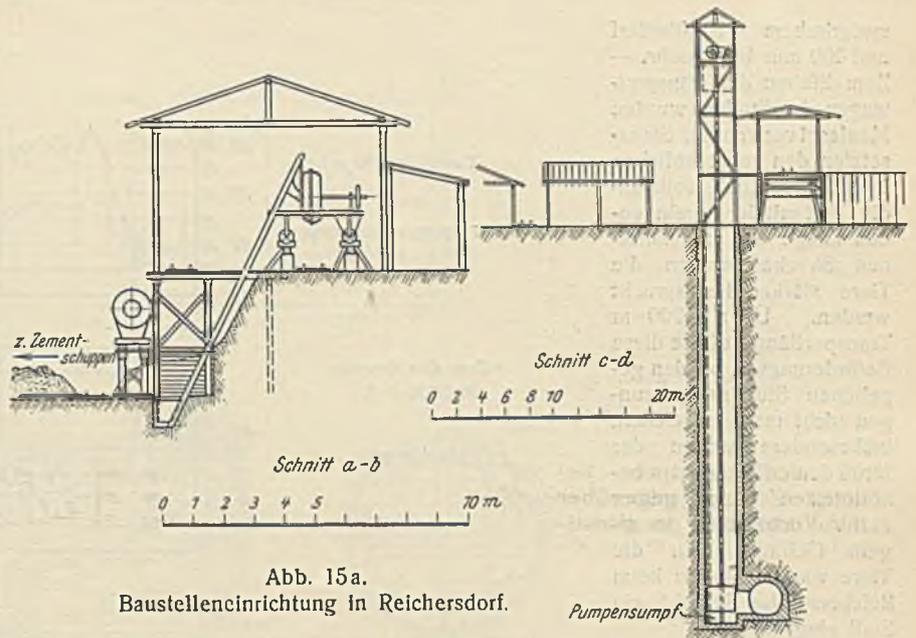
Baustelleneinrichtung in Reichersdorf.
